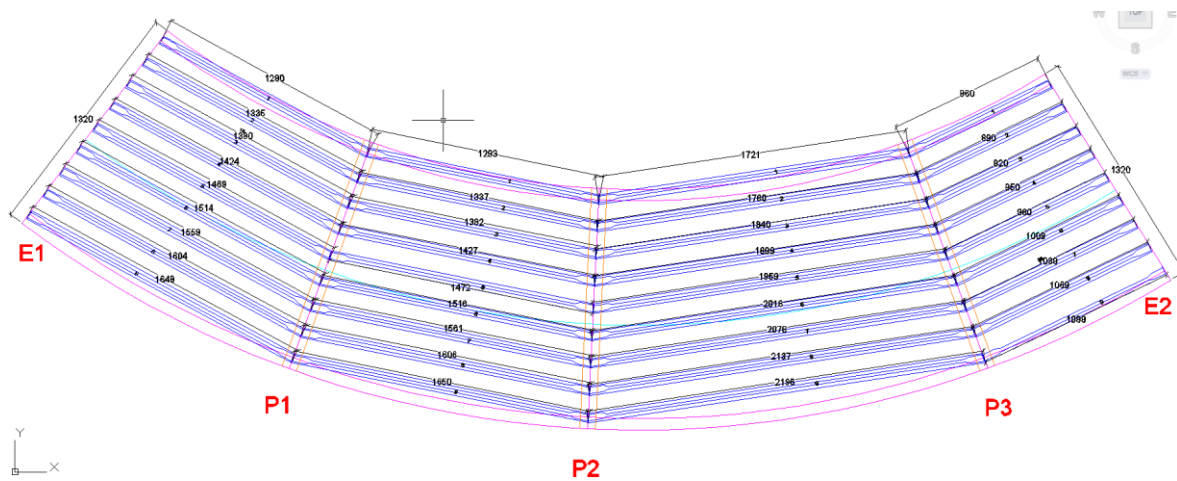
VISTA EN PLANTA DE LAS VIGAS DEL PUENTE AGUA DULCE
